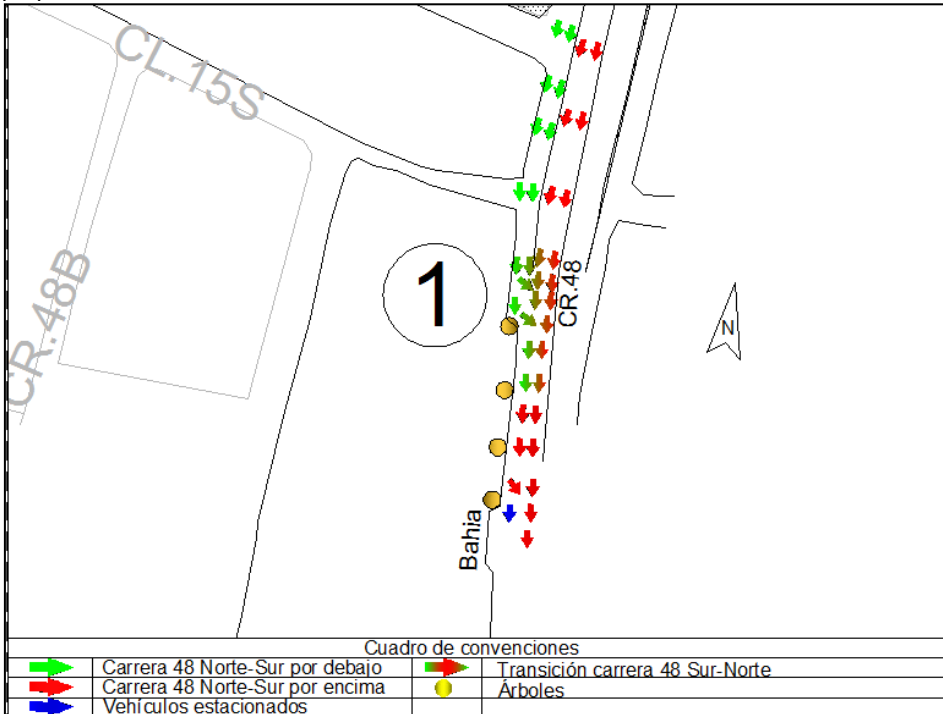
Bahía sobre la carrera 48. Fuente: elaboración propia.
